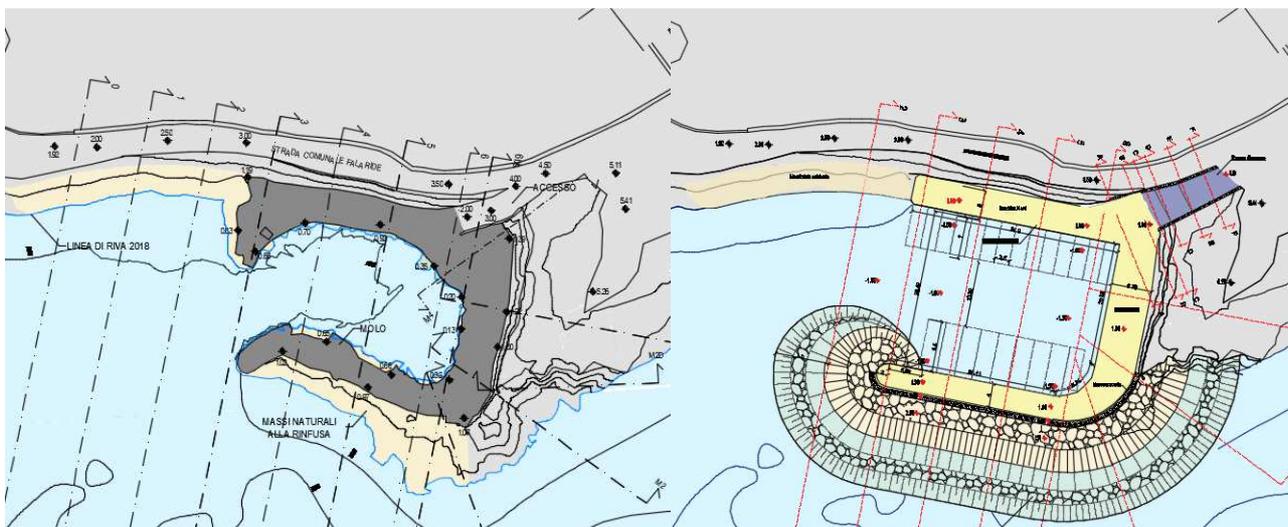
A sinistra planimetria stato di fatto, A destra planimetria di progetto.
